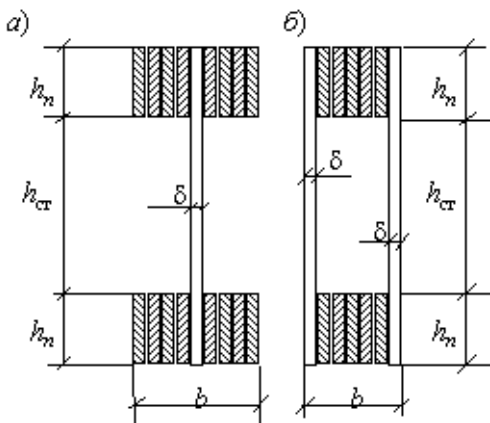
Поперечные сечения клееных балок с плоской фанерной стенкой
